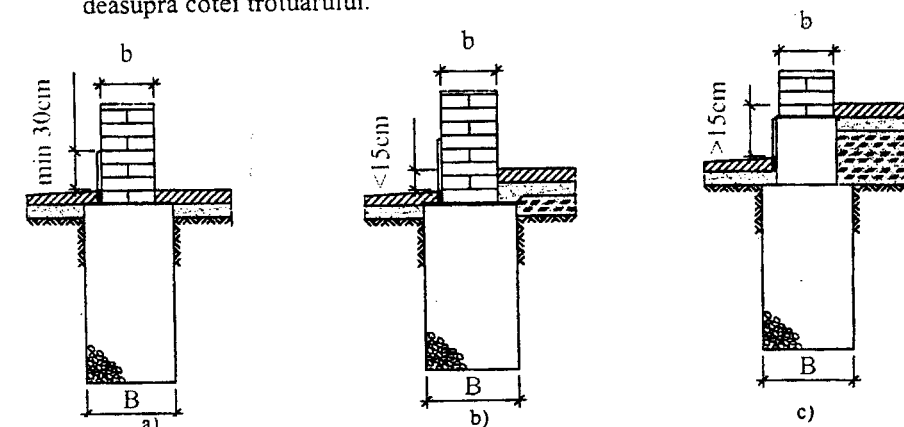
Fundații la pereții exteriori ai clădirilor fără subsol
